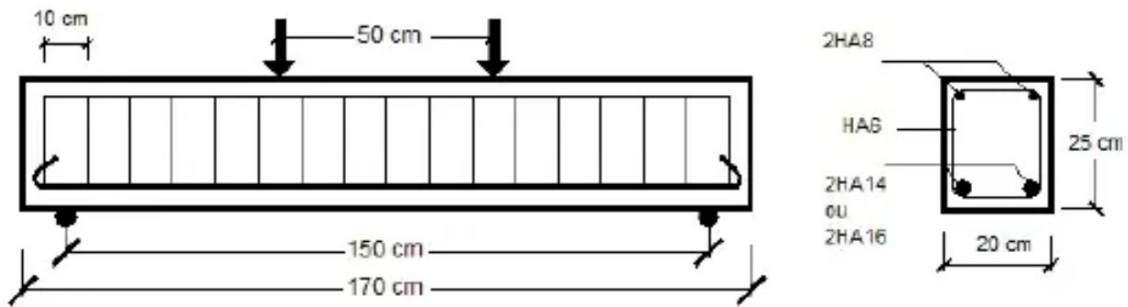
Essai de flexion 4 points et plan de ferrailage [50].
